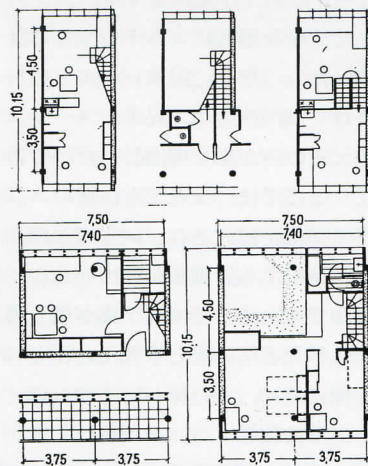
「ナルコムフィンのドーム・コムナ」各階住戸平面図
